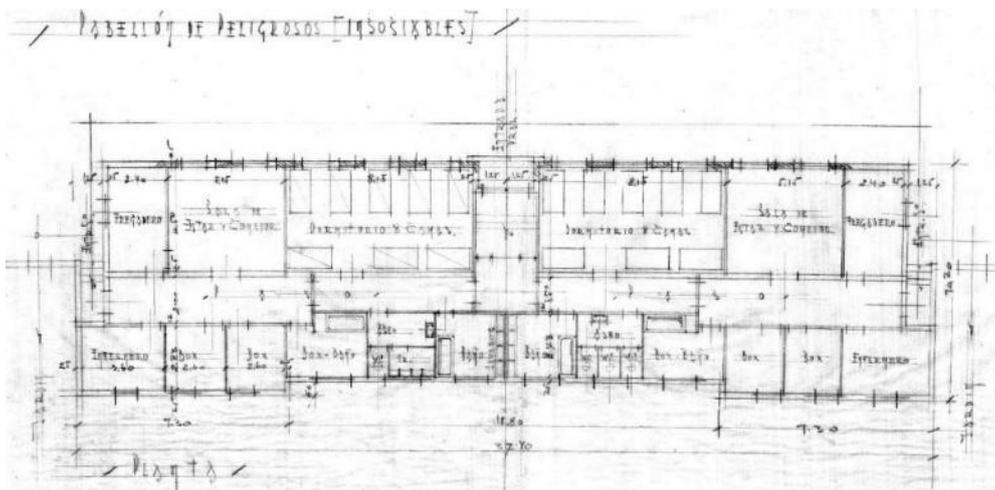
Planta del Proyecto original de 1931.
